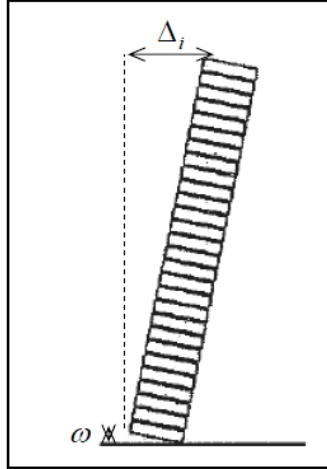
Ancho de grietas ω en la base durante el balanceo (Restrepo, 2003).
